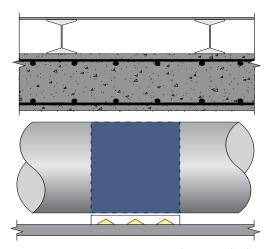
Схема организации монолитного железобетонного безбалочного перекрытия
